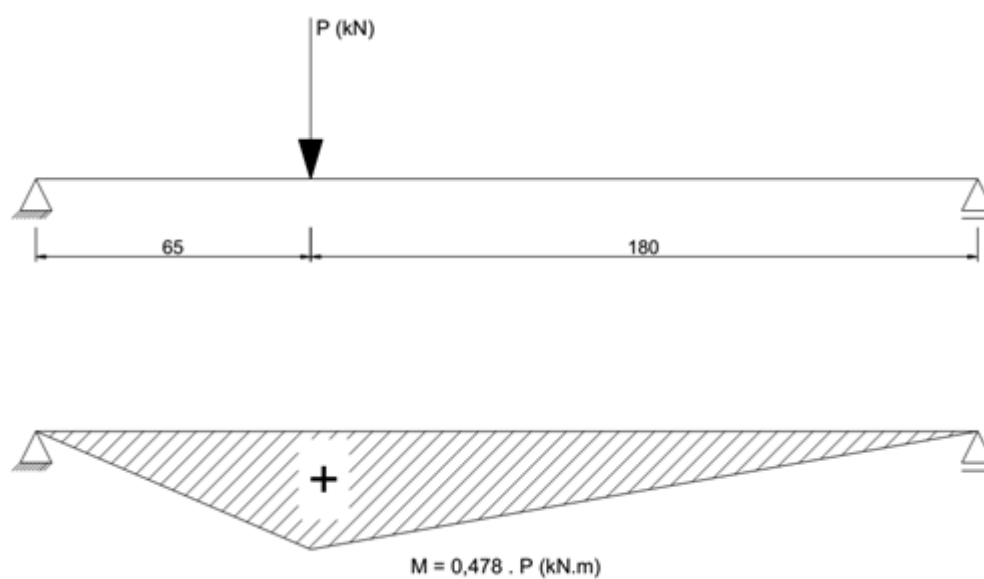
Esquema de ensaio – Vigas do Grupo 1
